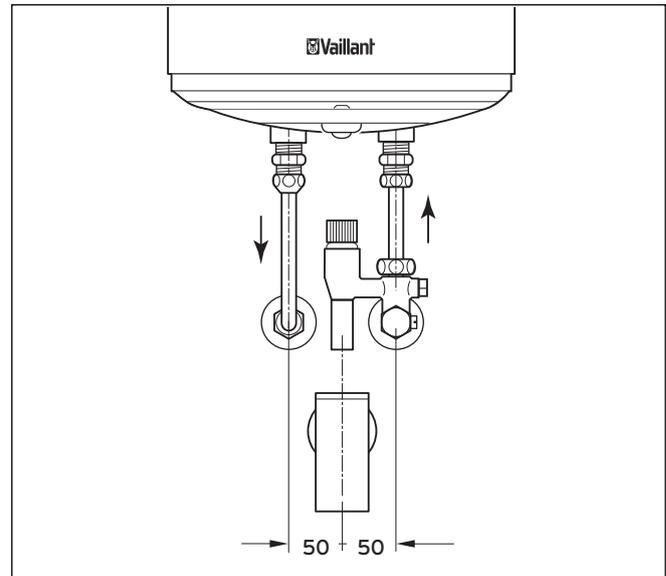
Vorderansicht bei geschlossenem System (Maße in mm)
